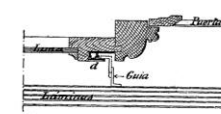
Cierre sistema Chédeville: detalle de una guía intermedia.
